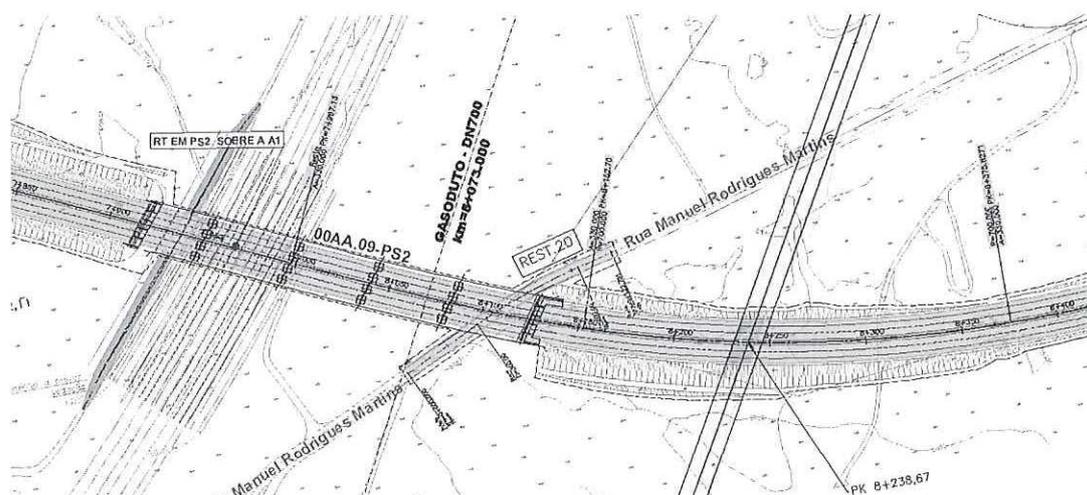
SOLUÇÃO A DO TRAÇADO DA RAVE (ASSINALADO A AMARELO)
